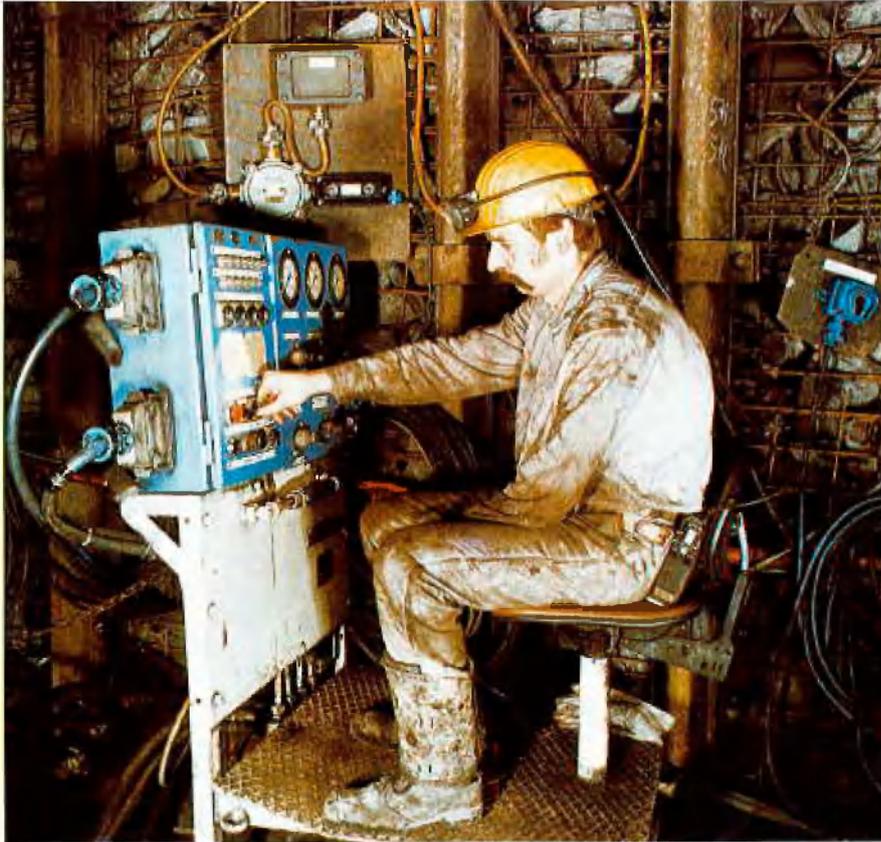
Bohrmeister Dietmar Welter am Steuerstand der Raise-Bohrmaschine
